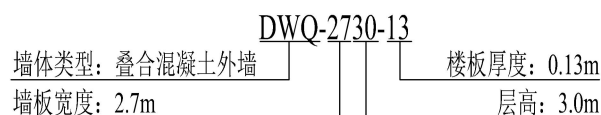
无洞口叠合混凝土外墙编号规则示意图
